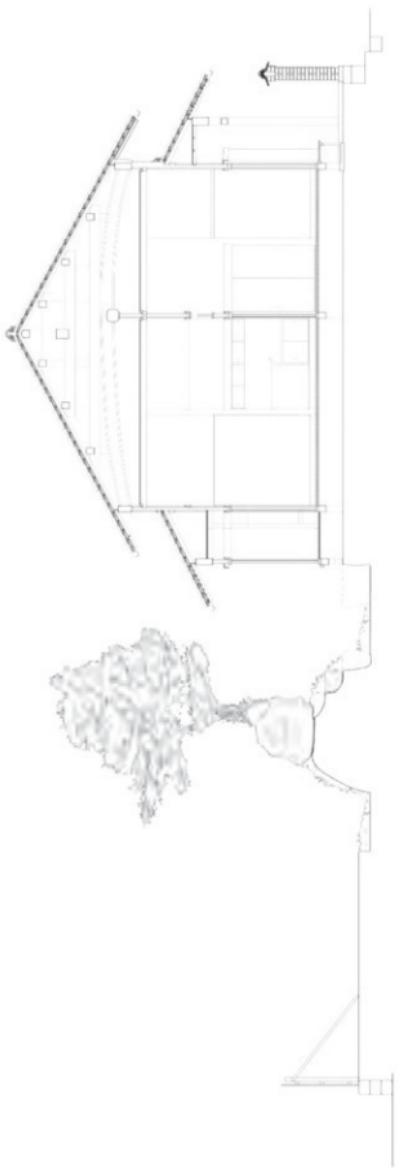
森山家住宅 断地断面図 主屋才モヤ 1:100
